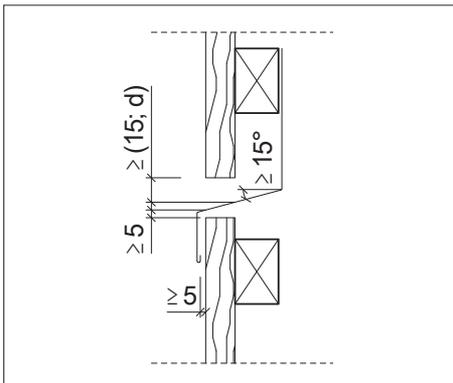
Horizontale Stoßfuge bei vertikaler Brettbekleidung, Abdeckung mit Z-Profil.
